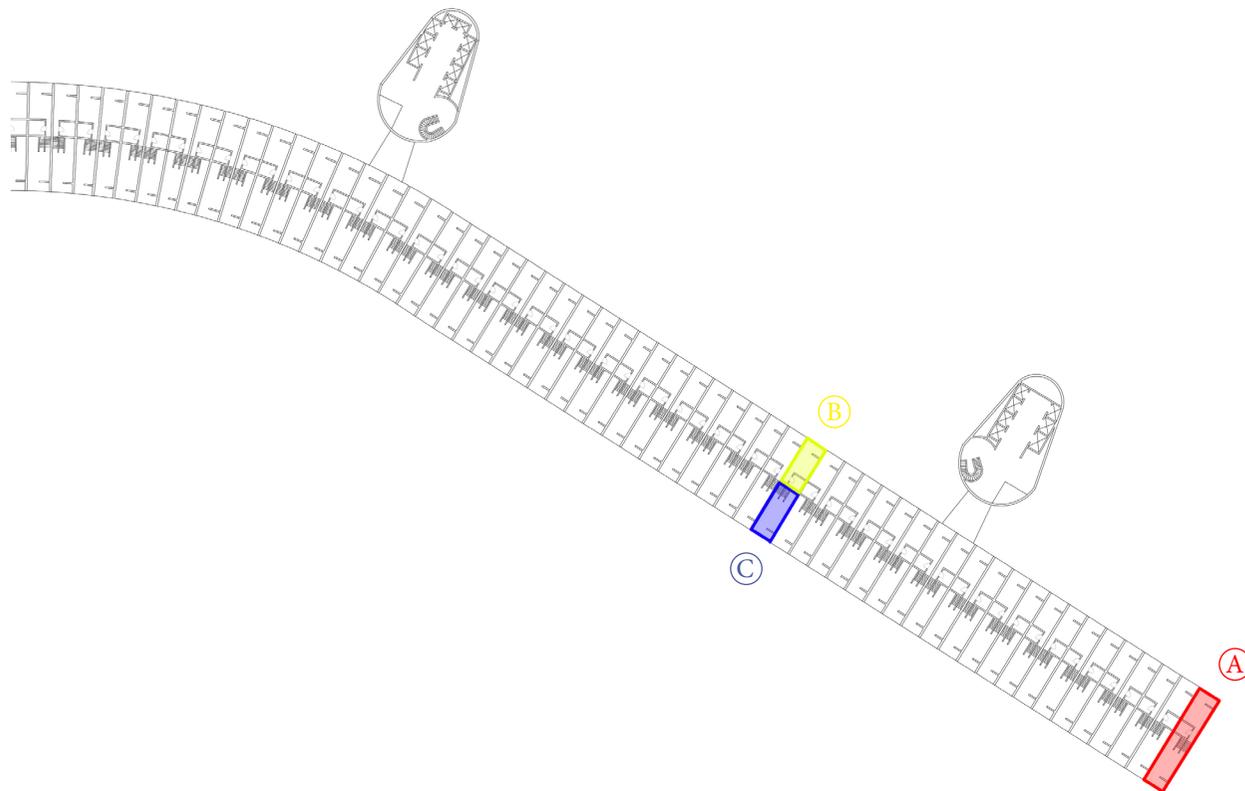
Esquema de la planta tipo indicando las distintas tipologías de vivienda.
